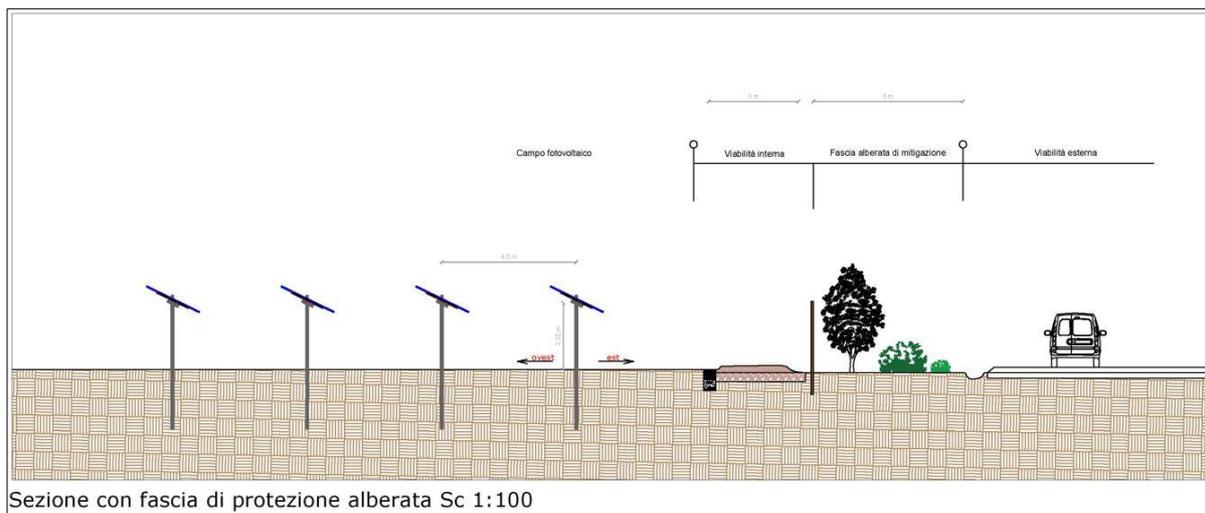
sezione tipologica con gli elementi accessori dell'impianto – strade, interne e perimetrali, recinzione e fascia alberata di mitigazione;
